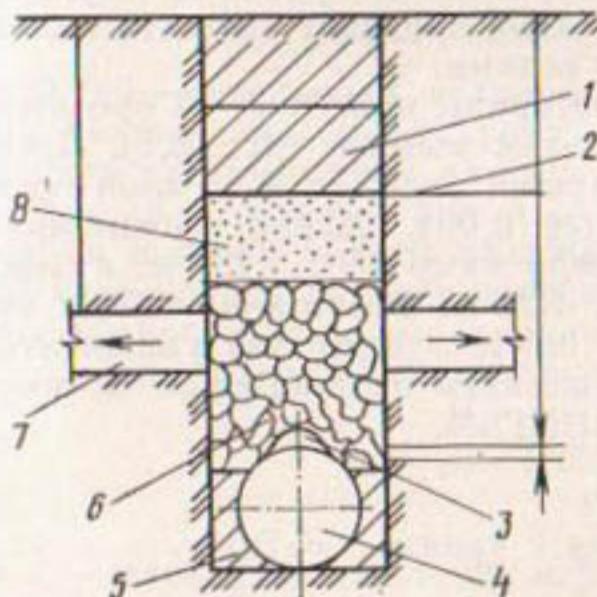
Поперечный разрез траншеи с оросительным трубопроводом:
